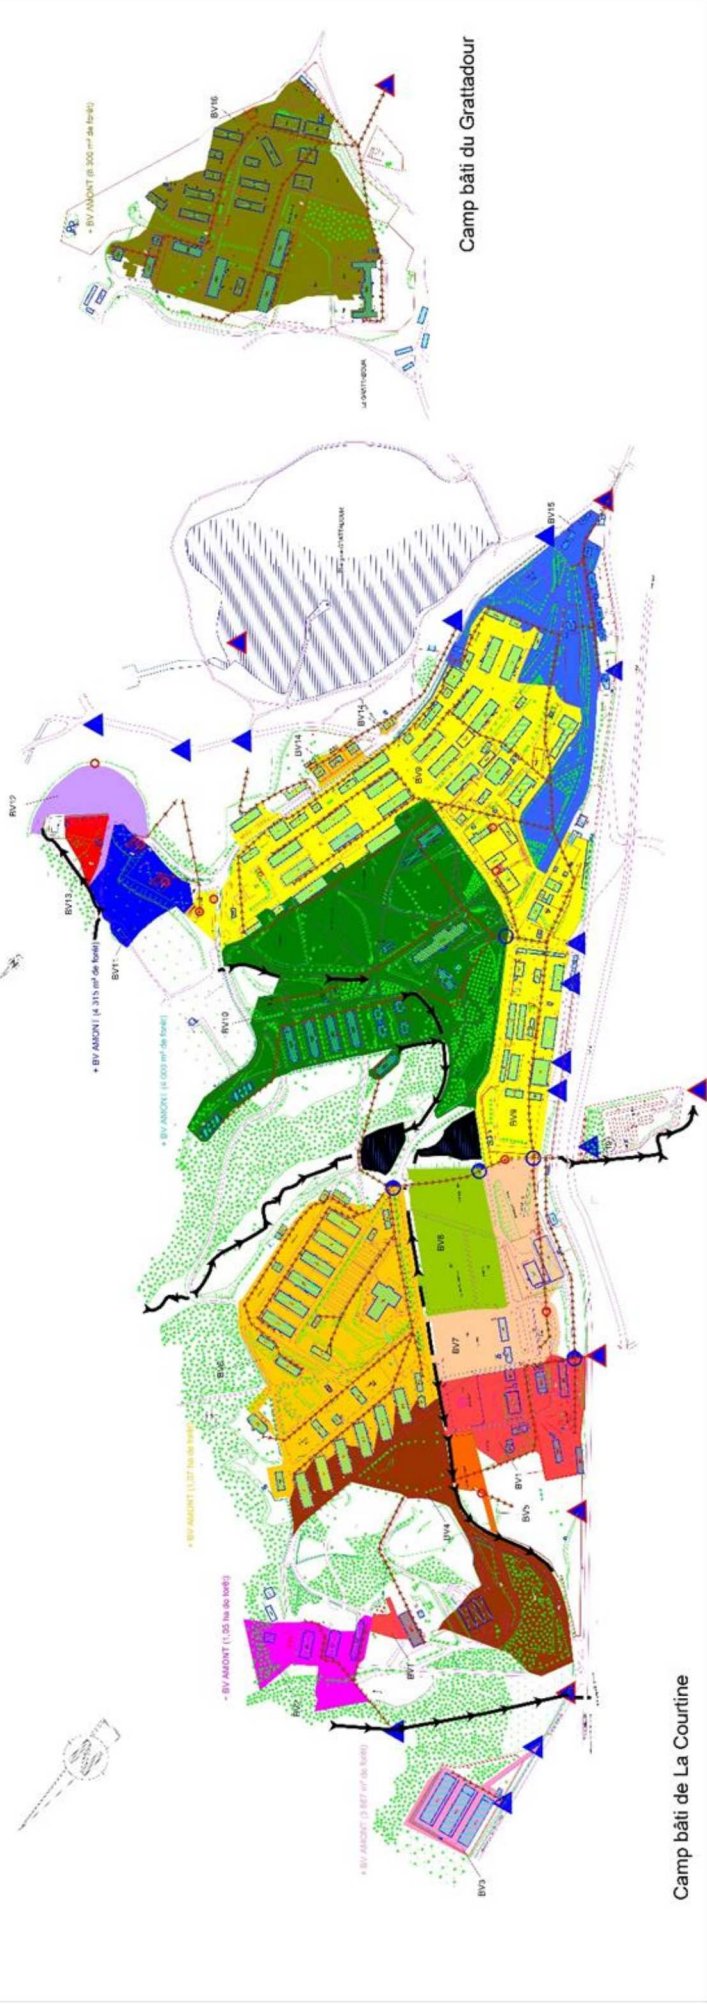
Bassins versants pour la gestion des eaux pluviales (fond de plan : plan topographique transmis par le camp de la Courtine)
